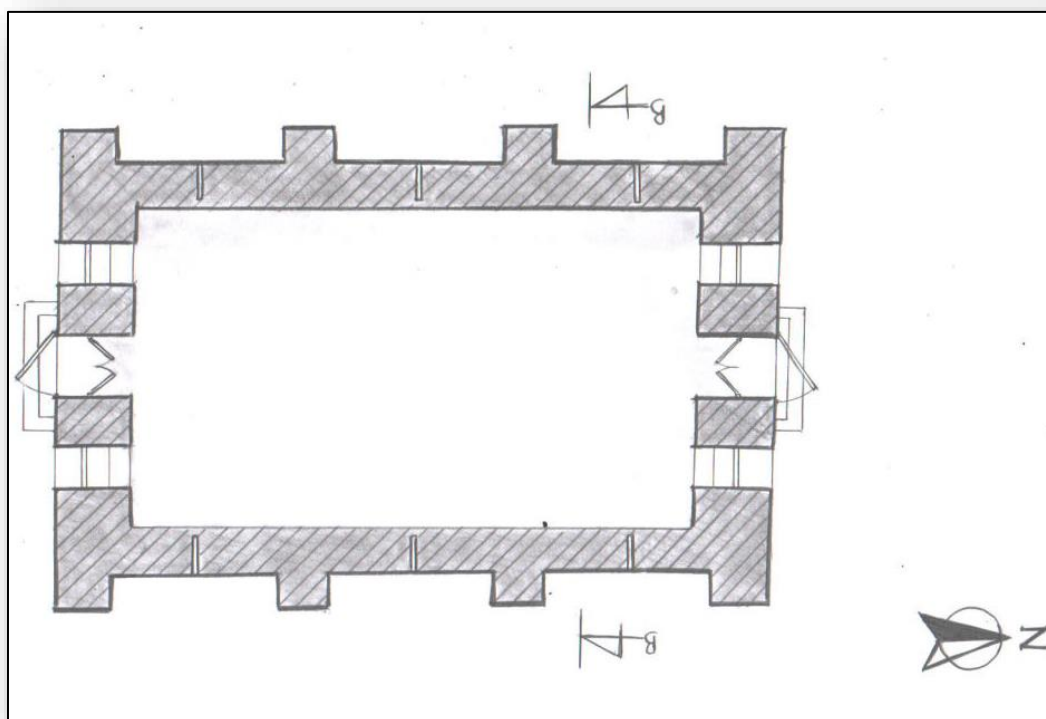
Vue En Plan Du RDC La Poudrière De La Citadelle.
